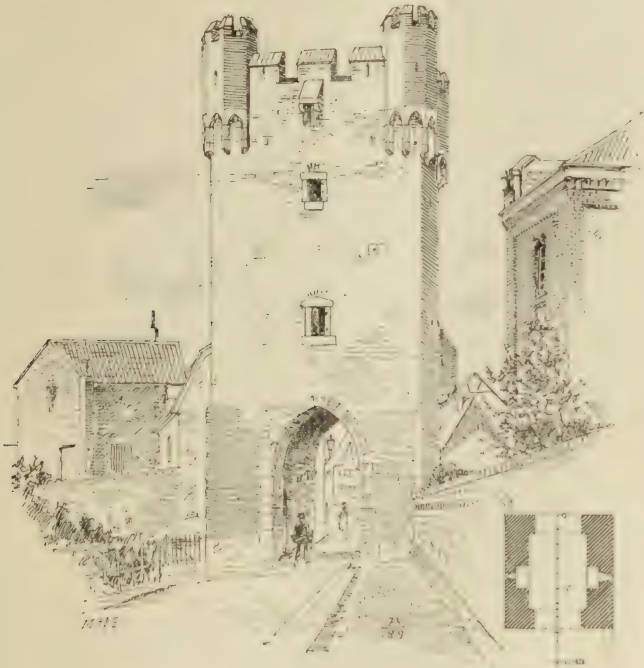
Zulpich. Grundriss und Ansicht des Münsterthores.
